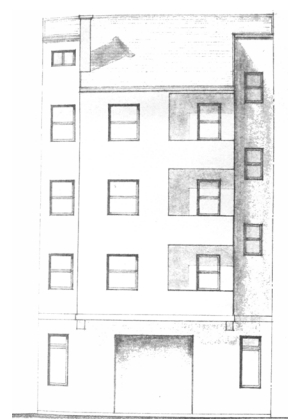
Plano del alzado posterior del edificio ubicado en la Rúa Celso Rivas Pérez, 7 (fotografía de autoría propia).
